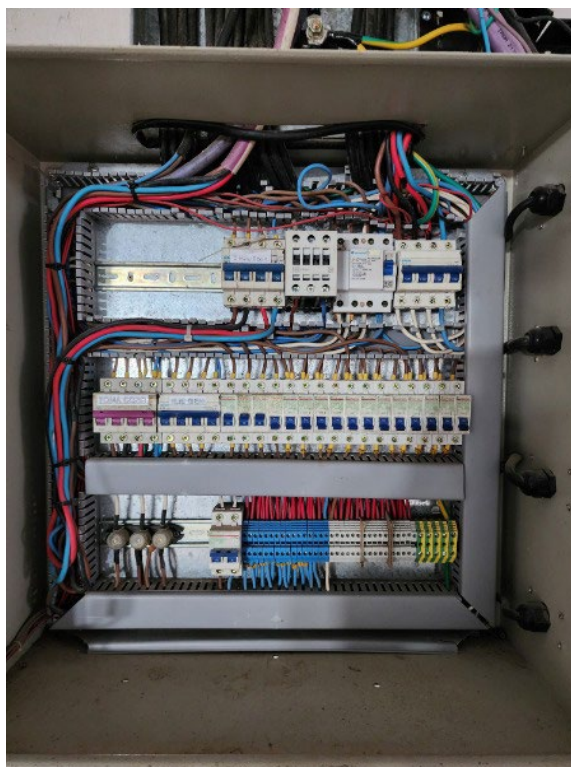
Tablero principal de la zona de administración, oficinas y de distribución secundario hacia zona de administración.
